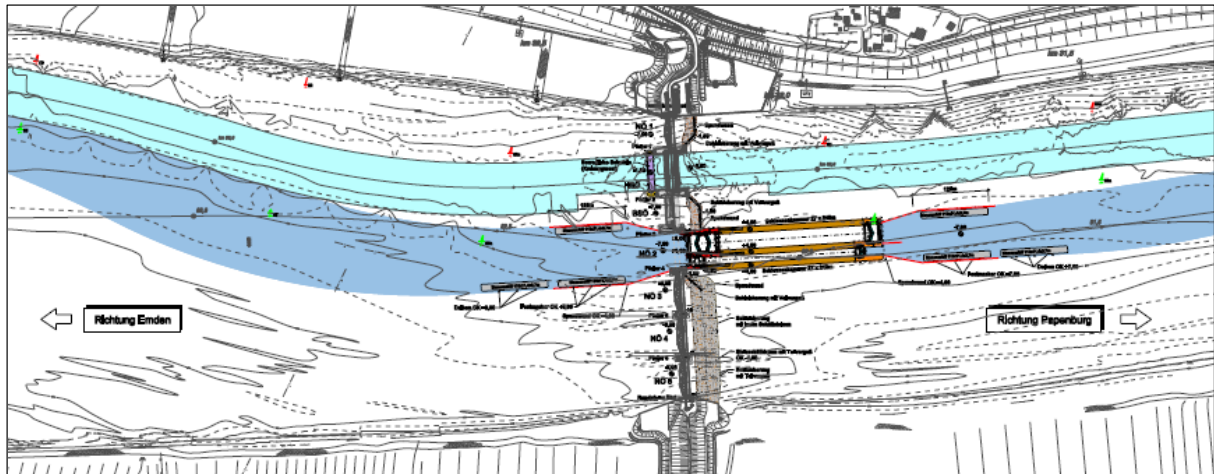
Lageplan der Gesamtvariante B.2 mit der Untervariante 3 - Doppelkammerschleuse
